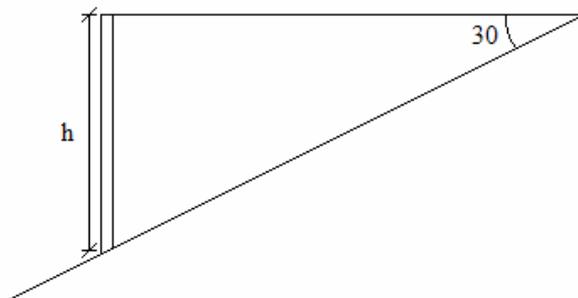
Section transversale d'un mur de soutènement et du terrain par lui soutenu
